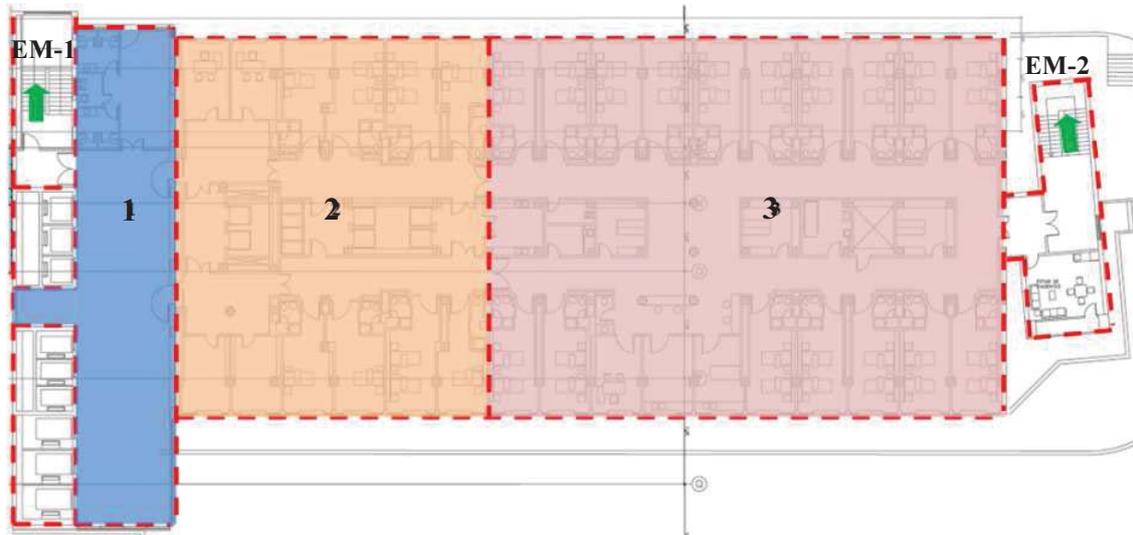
Layout y sectorización de la planta tipo de hospitalización.
